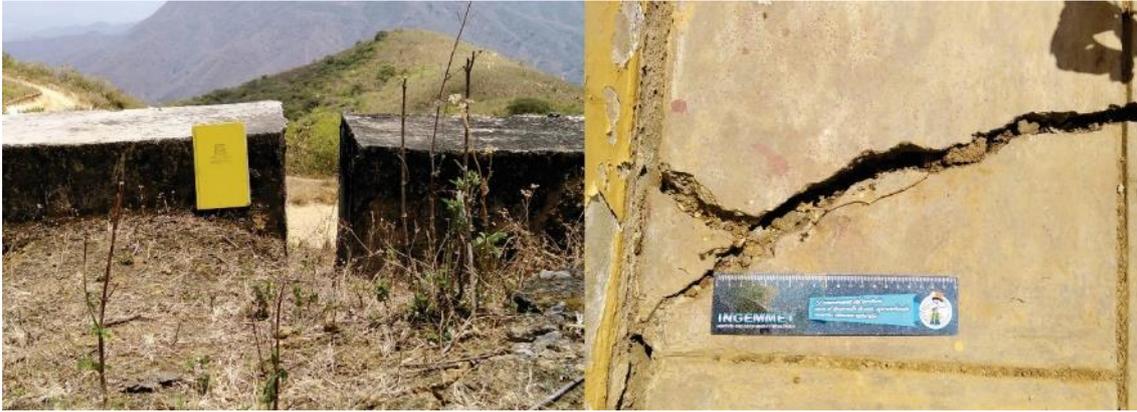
Muros de contención y veredas con grietas de hasta 5 cm de apertura.
